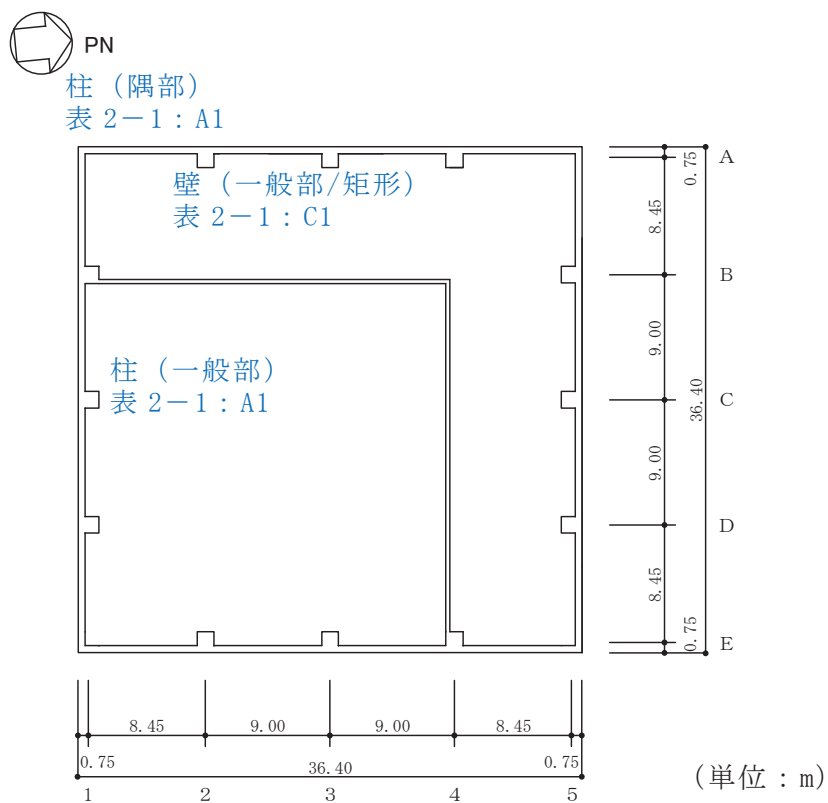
(4) 緊急時対策建屋の概略平面図 (0.P. 69. 4m)
